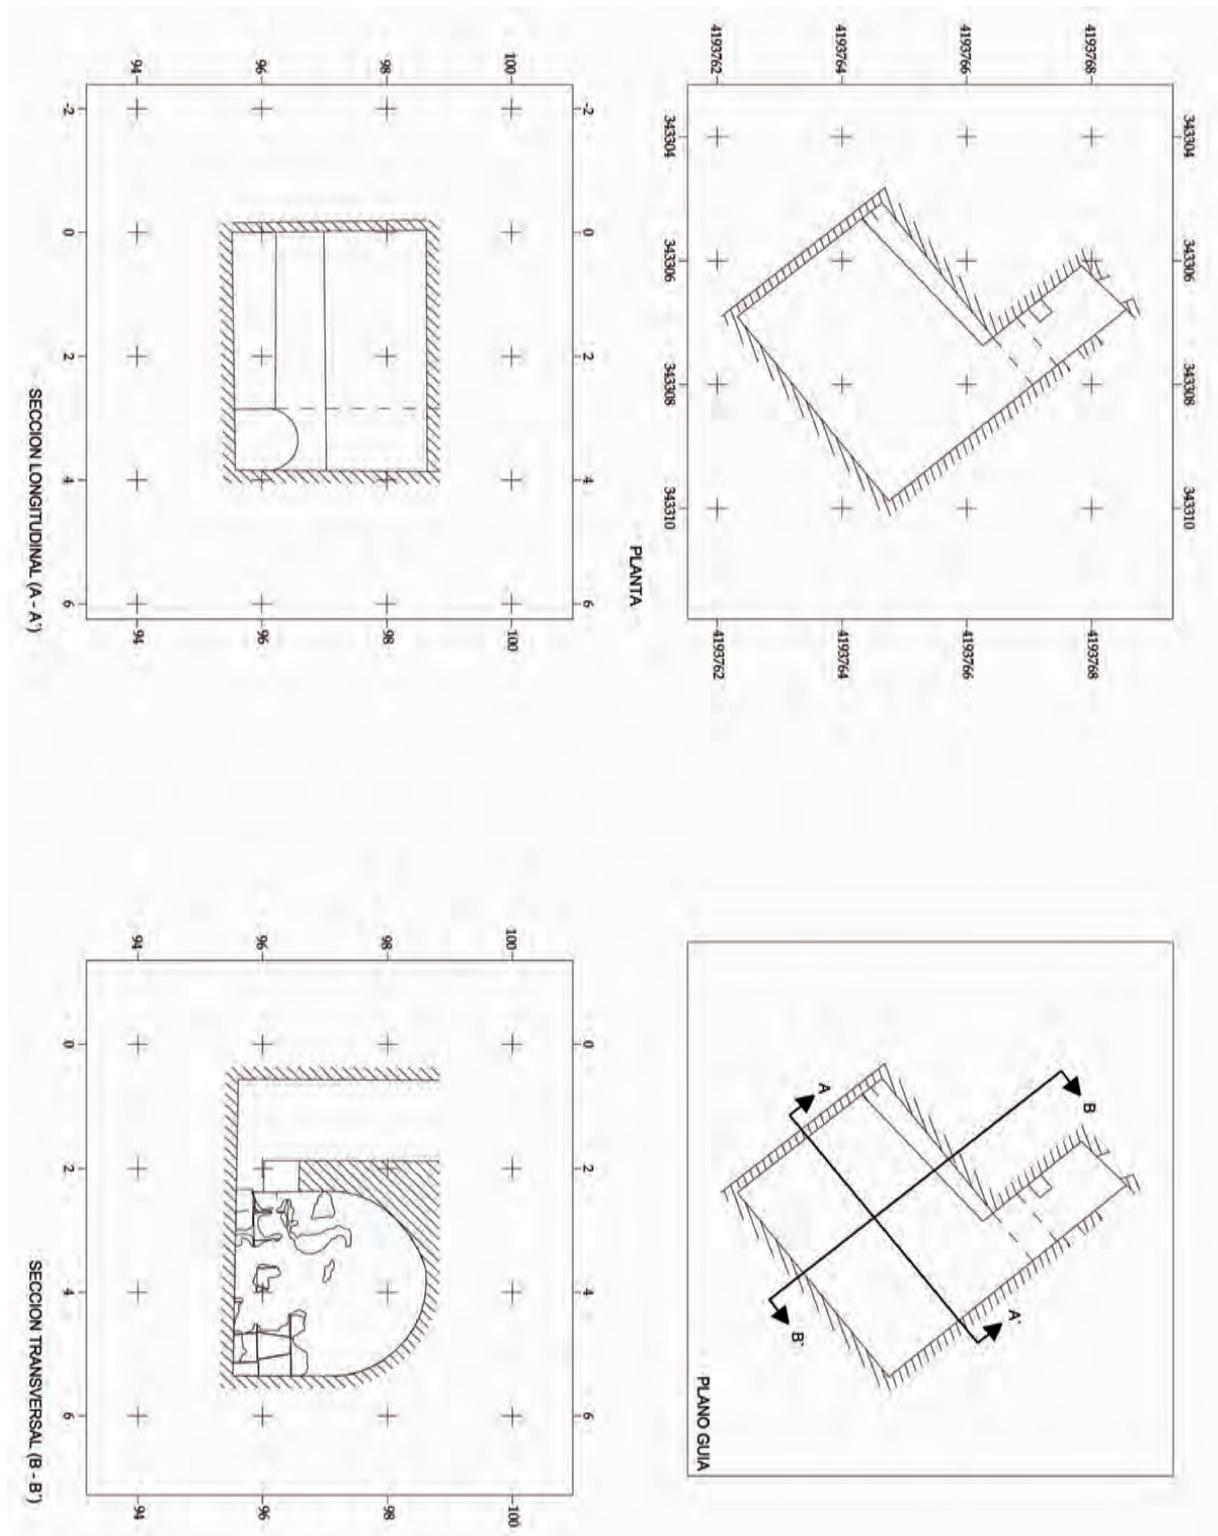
Corte 6. Planta y secciones de la estructura UE. 21.
